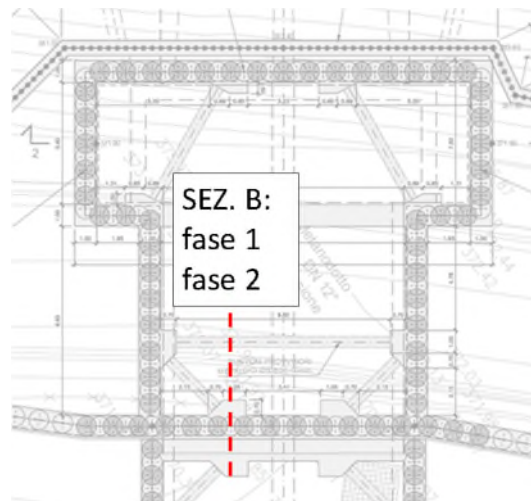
Pali tipo “B2” – Pianta - viste e sezioni
